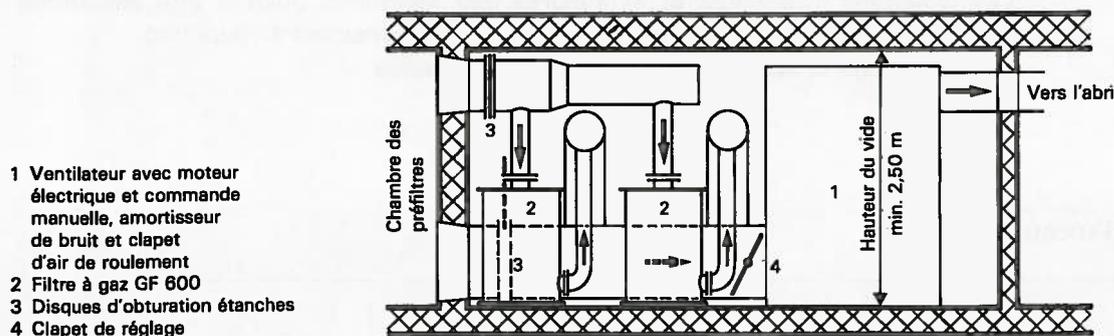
Système de ventilation avec appareil de ventilation central GF 600 (coupe)
